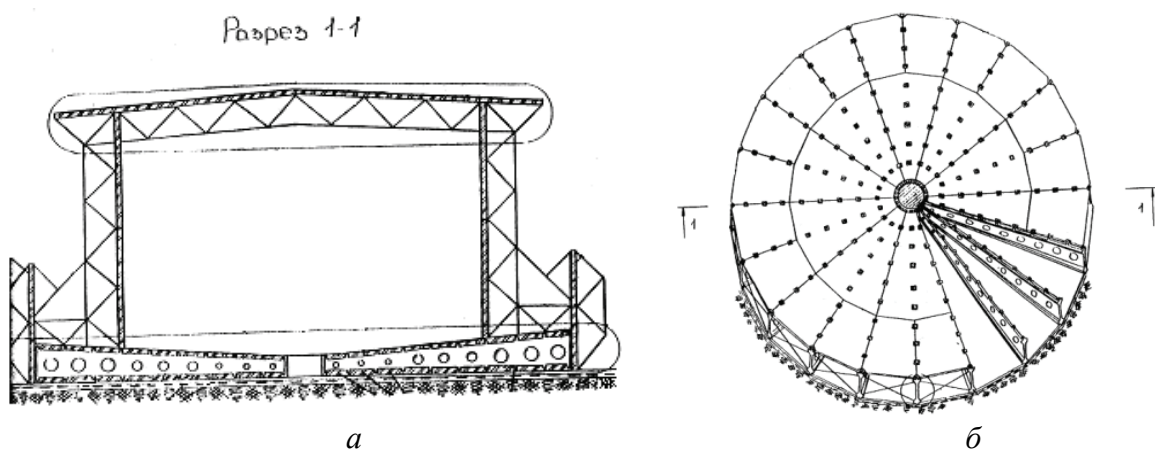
Пространственная фундаментная платформа на скользящем слое, объединенная с резервуаром в замкнутую систему, для строительства на слабых, вечномёрзлых, пучинистых грунтах и в сейсмических зонах: *a* – разрез 1-1; *б* – вид сверху. Патент РФ №2273697
